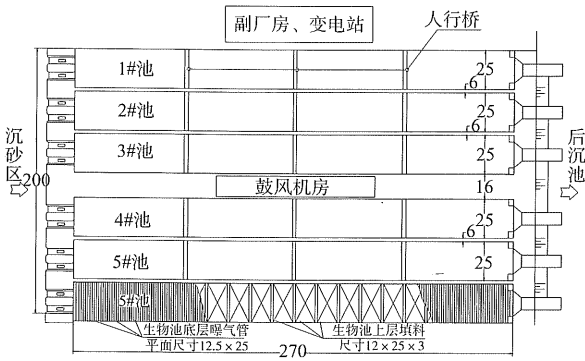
东深原水生物预处理工程平面布置图 (单位: m)
